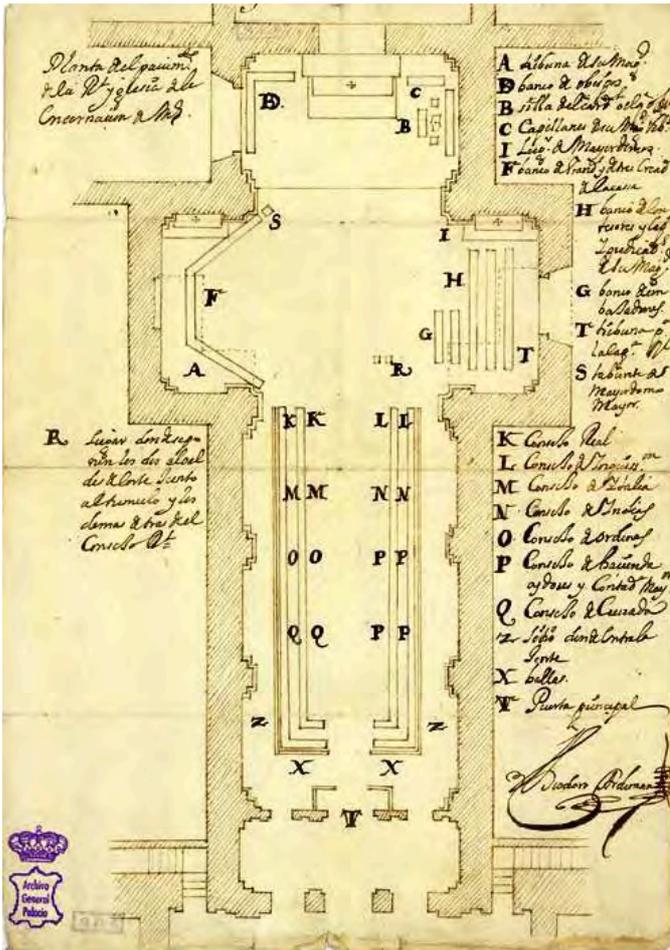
Teodoro Ardemán, *Planta del pavimento de la R.ª Iglesia de la Encarnación de Madrid*, c. 1712, AGP, Planos, P2661.
